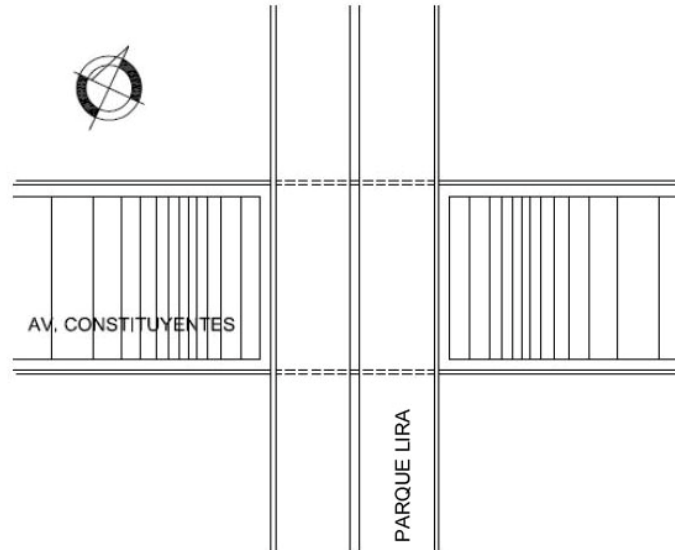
Vista de la planta del cruce entre las Avenidas Constituyentes y Parque Lira.
